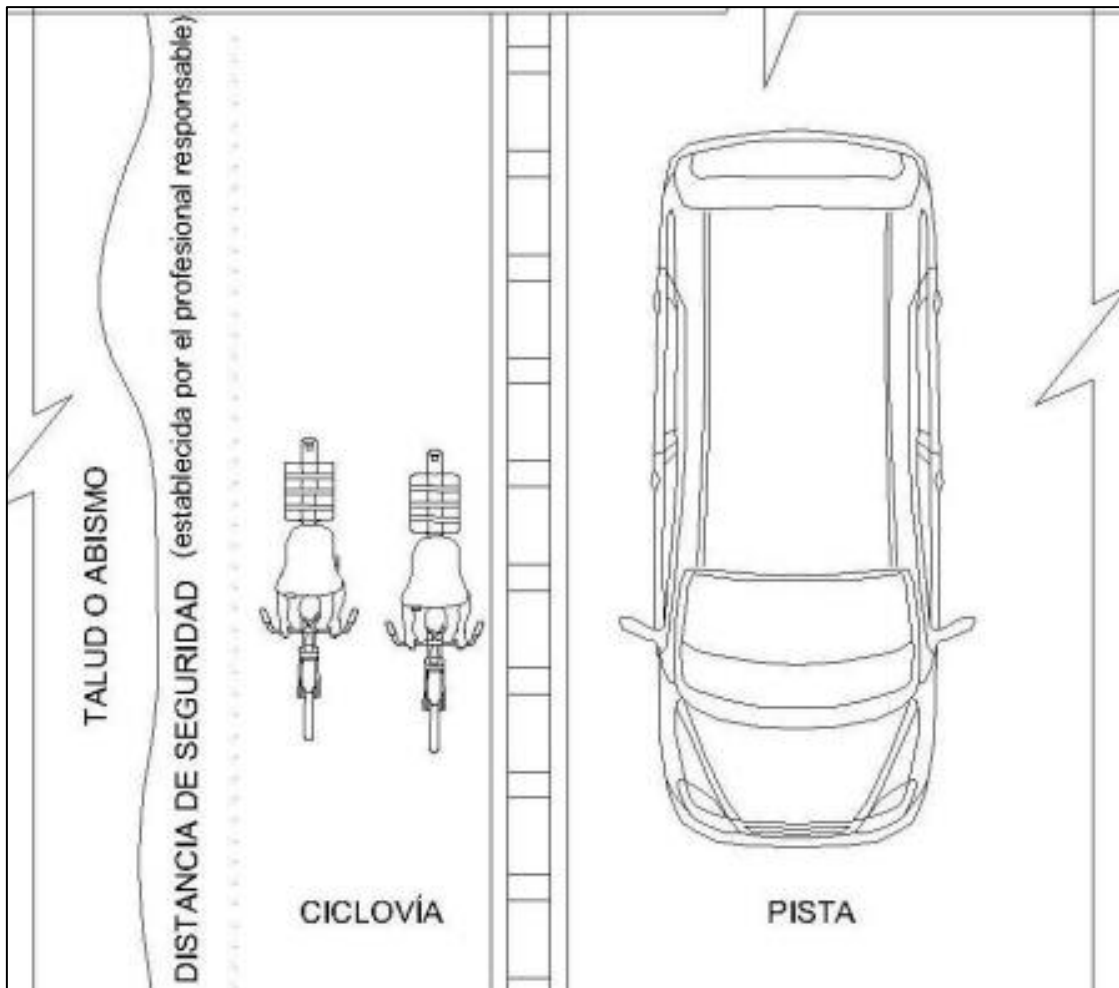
Ejemplo de elemento de segregación - tachones entre dos franjas pintadas y de un ancho de 10 cm - vista planta.
